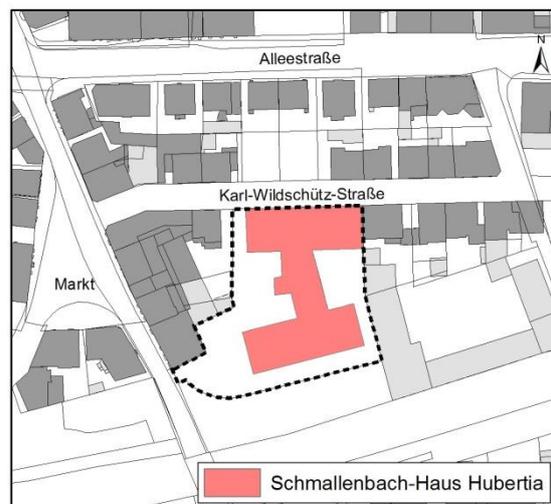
Lageplan Schmallenbach-Haus Hubertia
